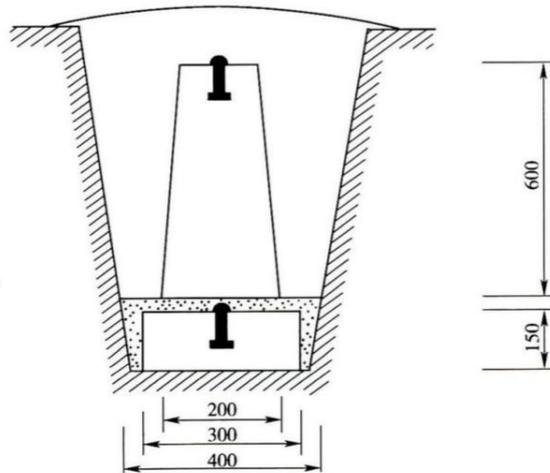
三等平面控制埋石点规格及埋设结构（单位：mm）
